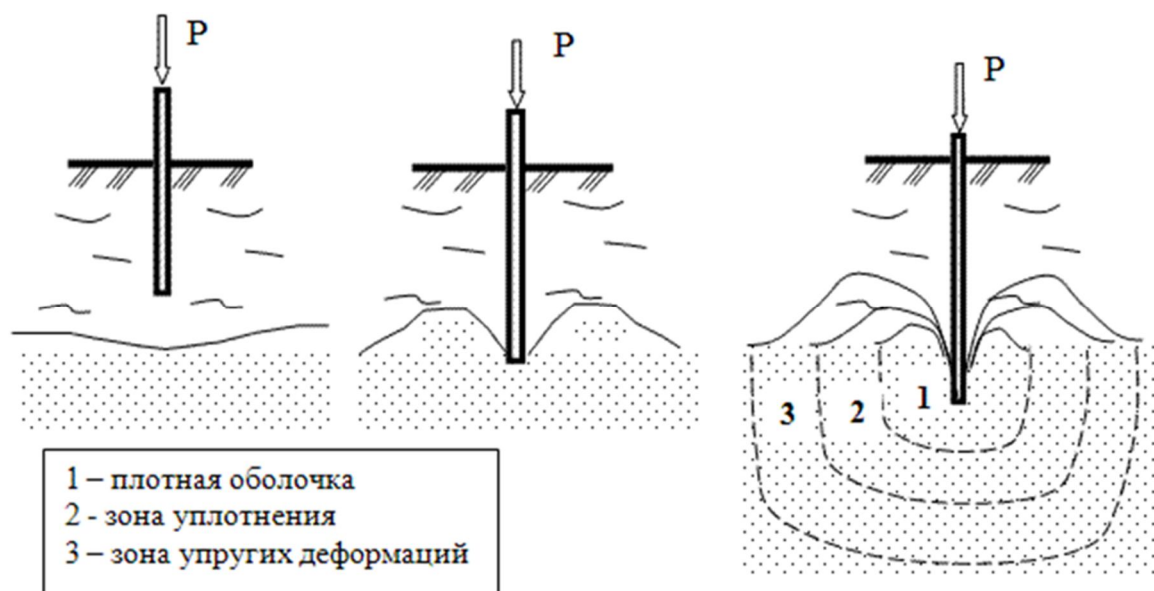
Схема погружения сваи с формированием зон уплотнения грунта
